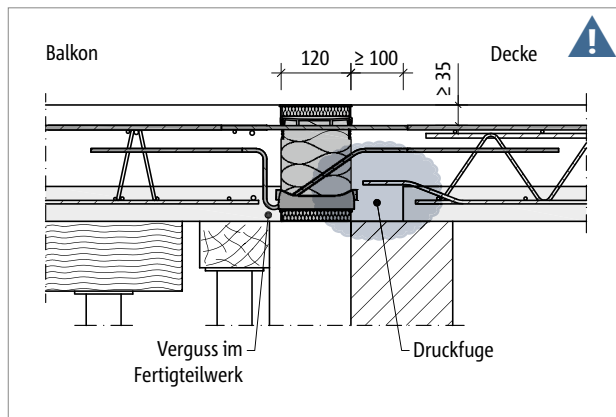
Schöck Isokorb® XT Typ KL-F: Druckfuge deckenseitig in Verbindung mit Halffertigteilplatten; direkte Lagerung
